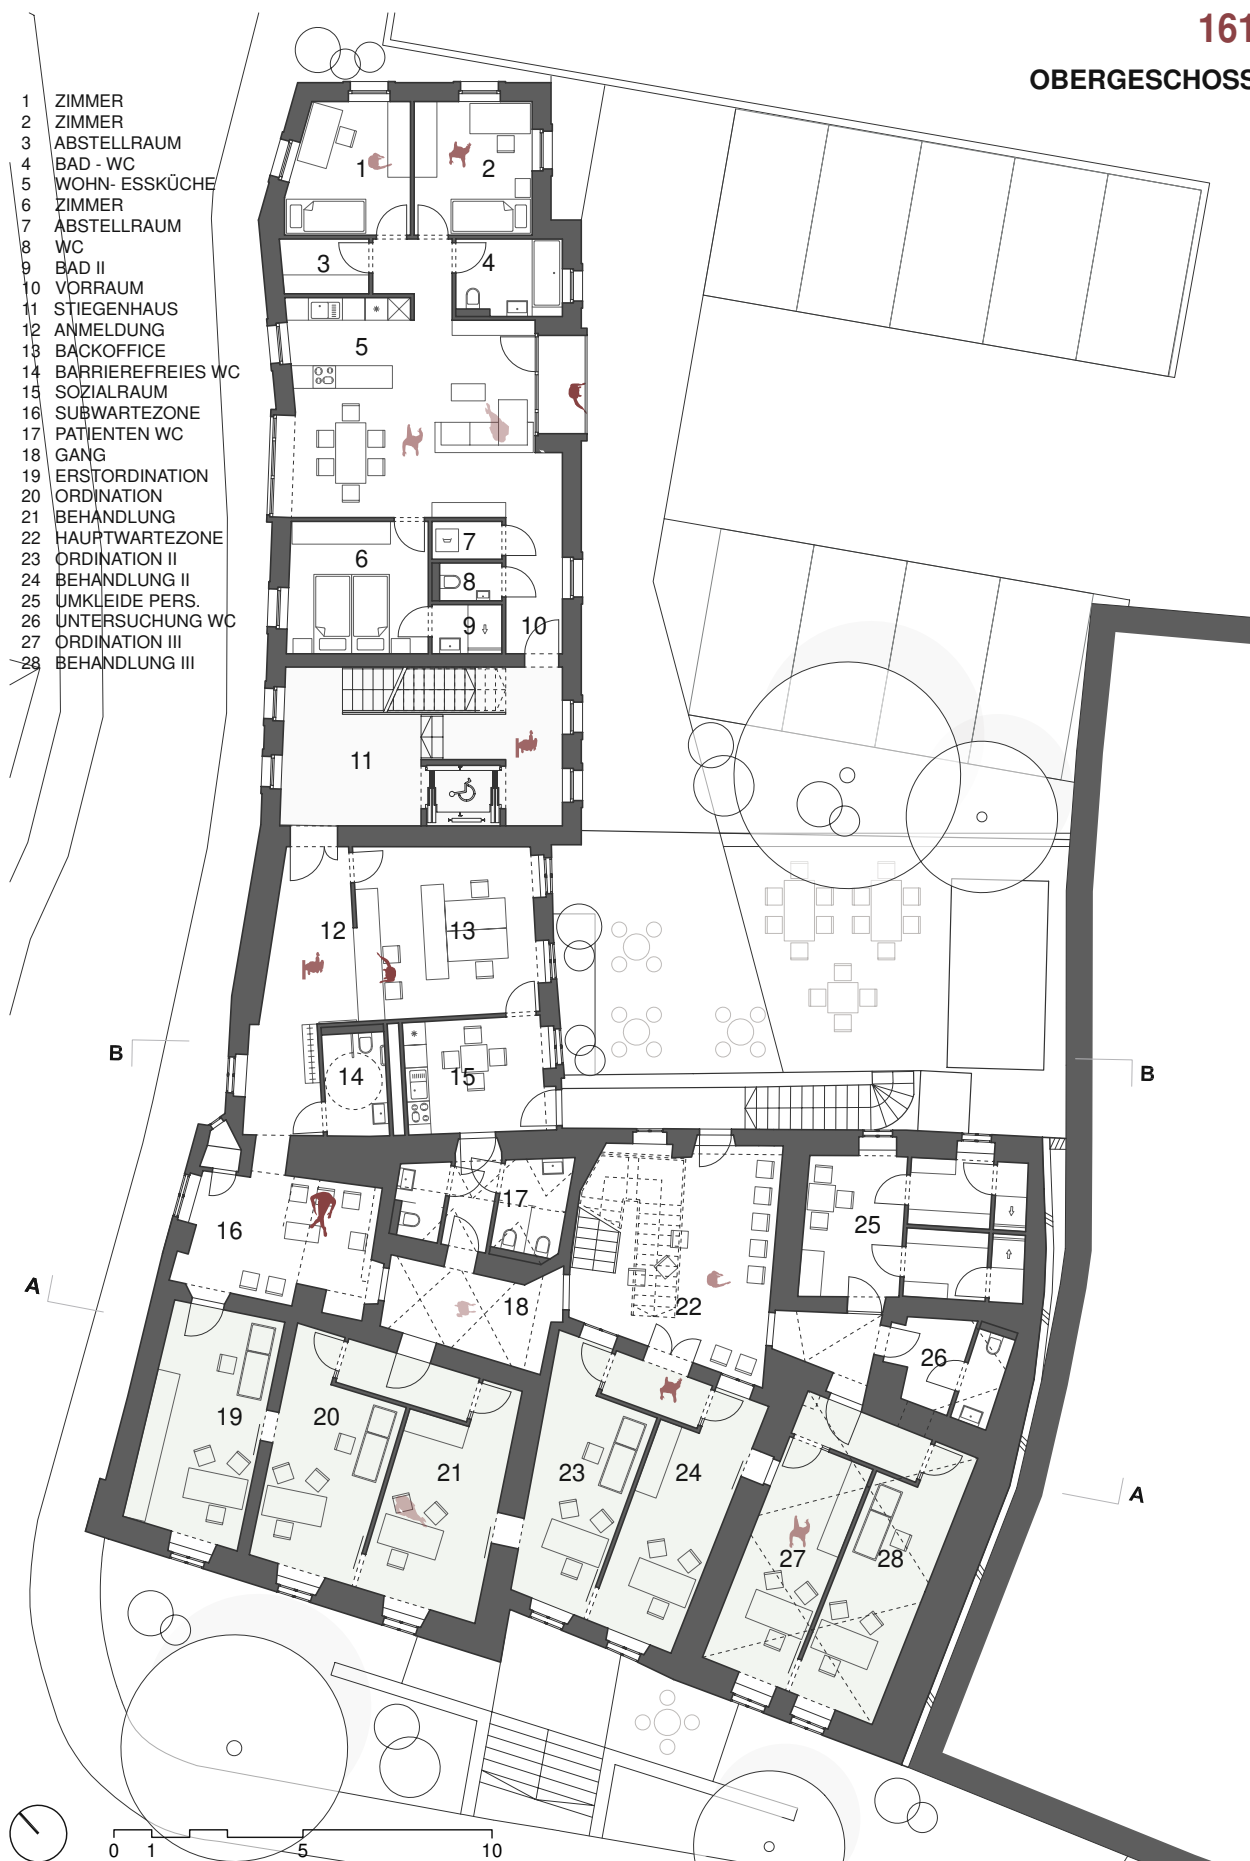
Entwurfsplan Grundriss Obergeschoß M 1:200
